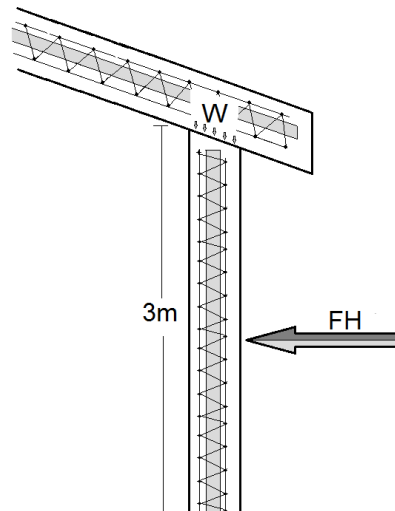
Cargas actuantes a muro vista en corte.
